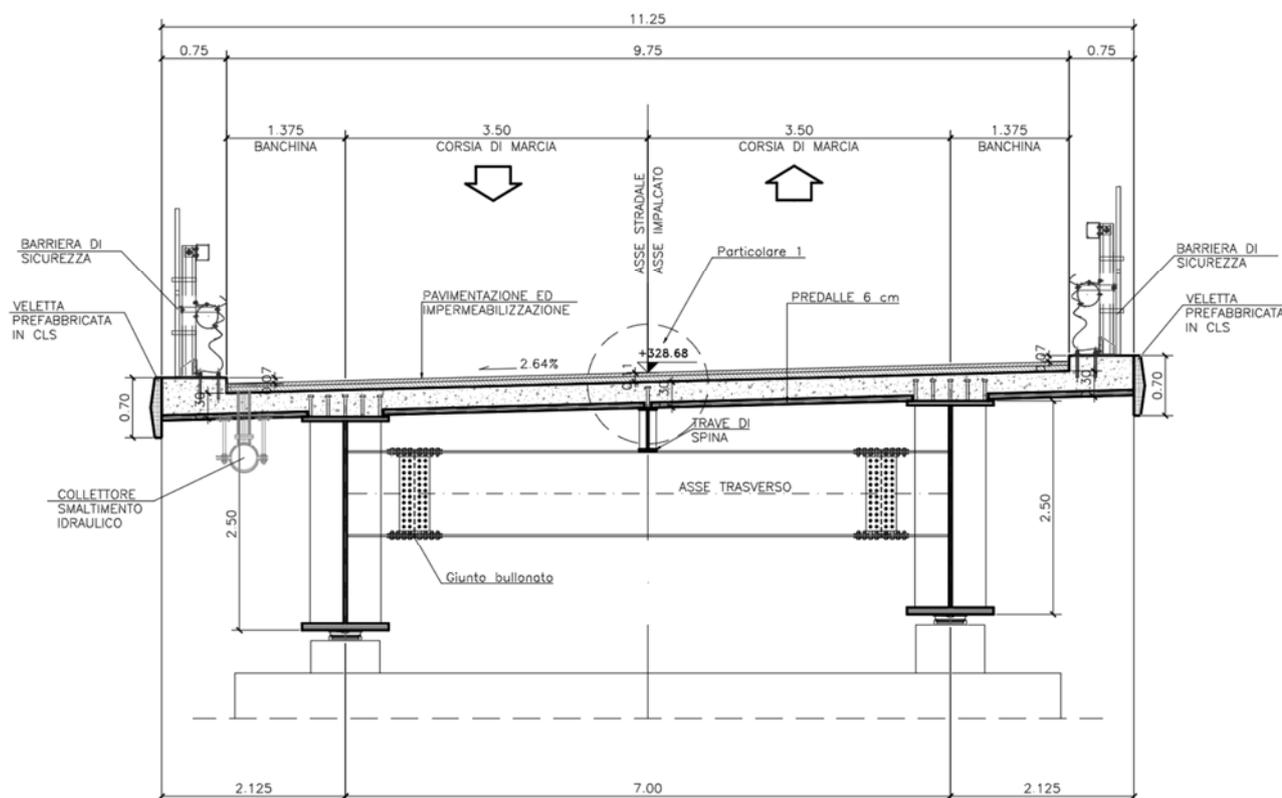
Sezione trasversale dell'impalcato del viadotto Marroggia
